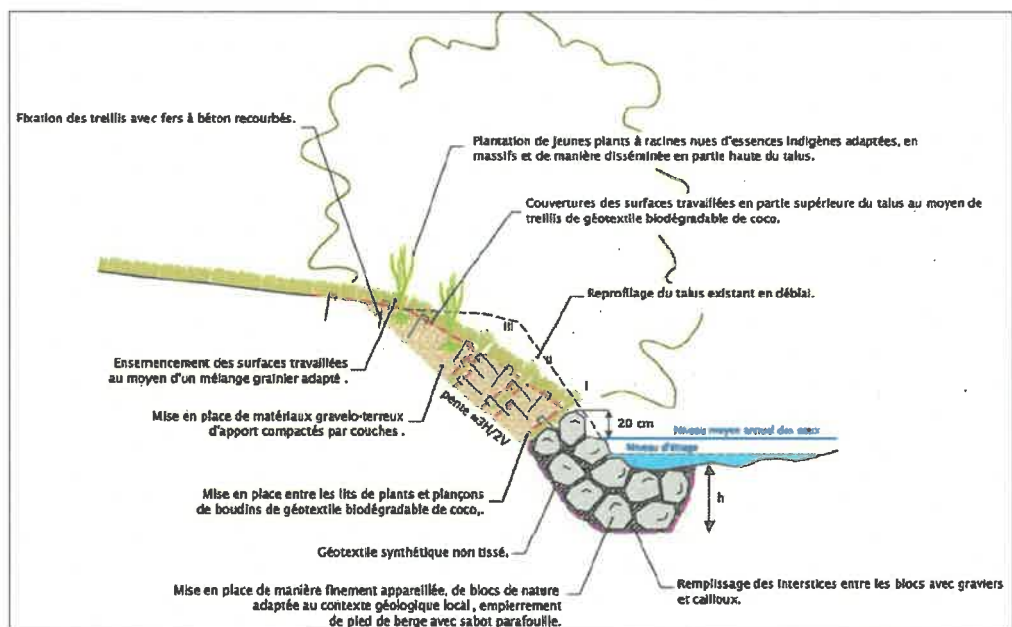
Coupe type d'une protection des berges par enrochement et génie végétal
